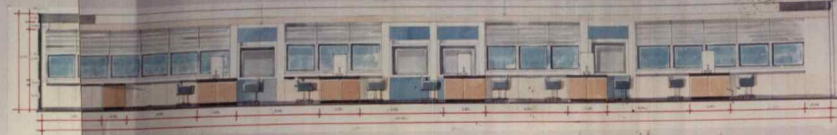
แสดงการ LAYOUT PLAN FURNITURE ELECTRICAL PLAN
